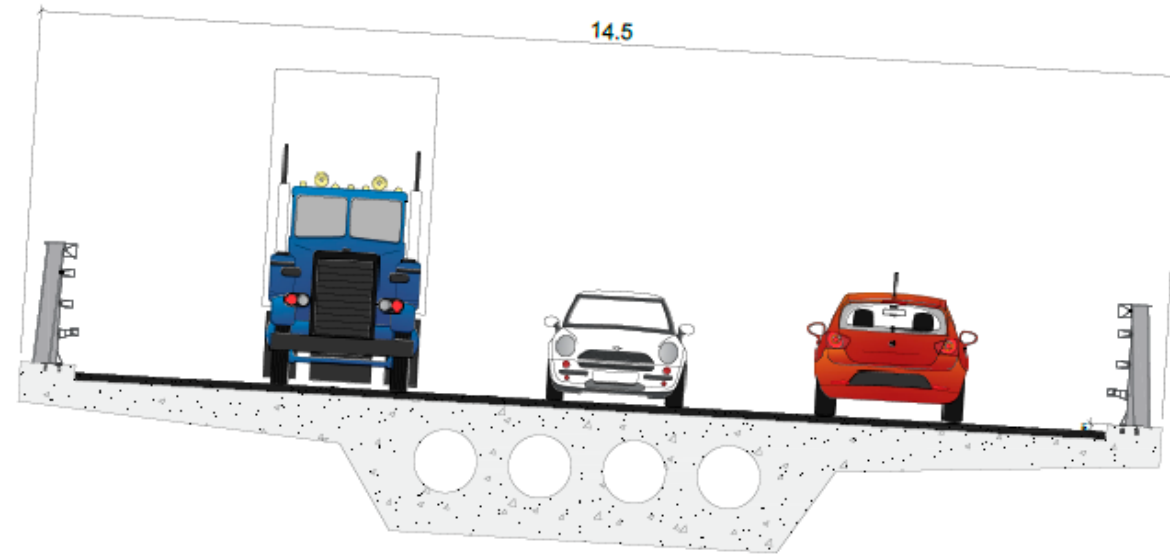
Sección tipo losa aligerada de la solución adoptada.
